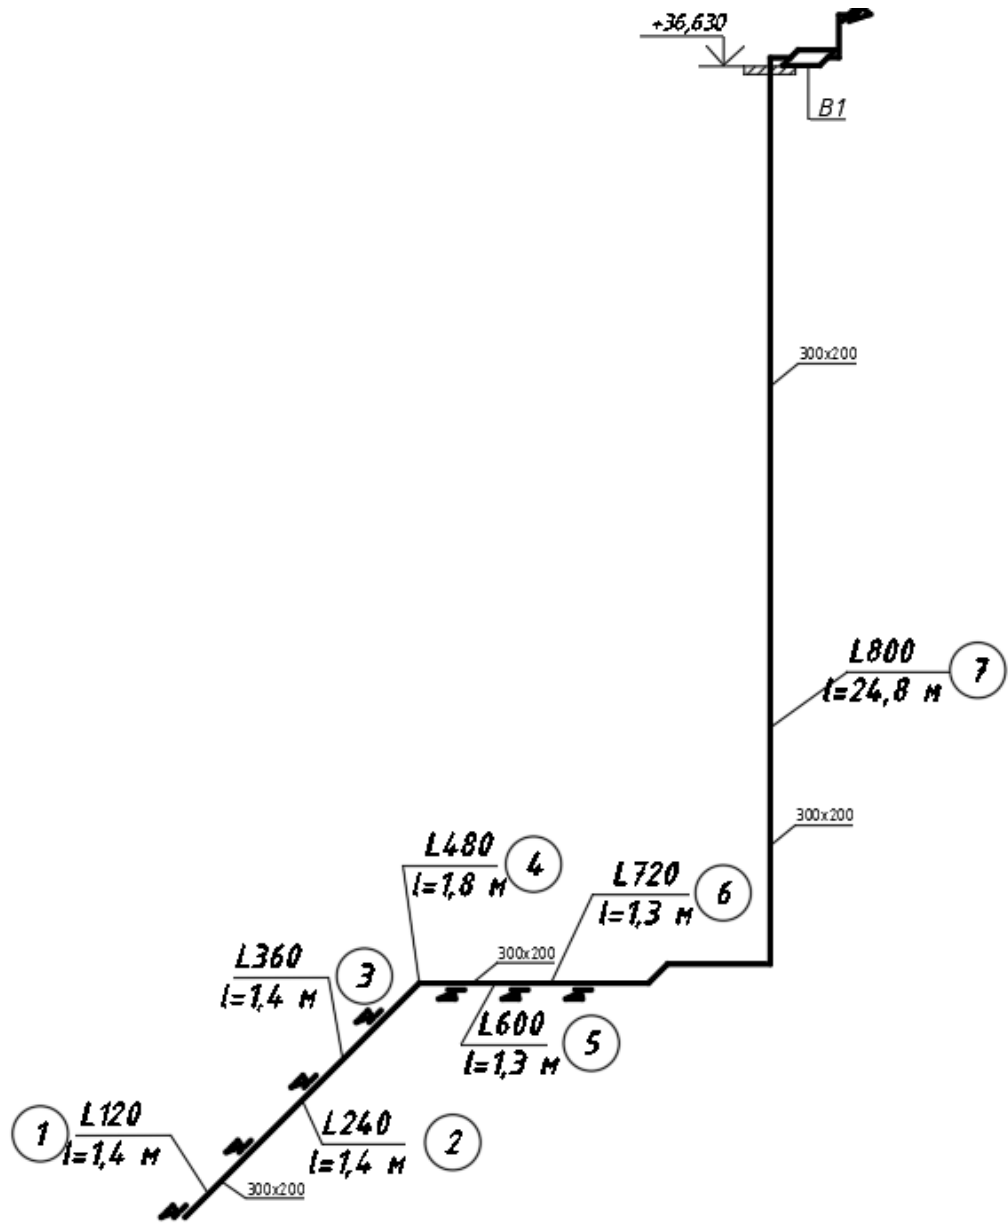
Расчетная схема вентиляционной системы В1
